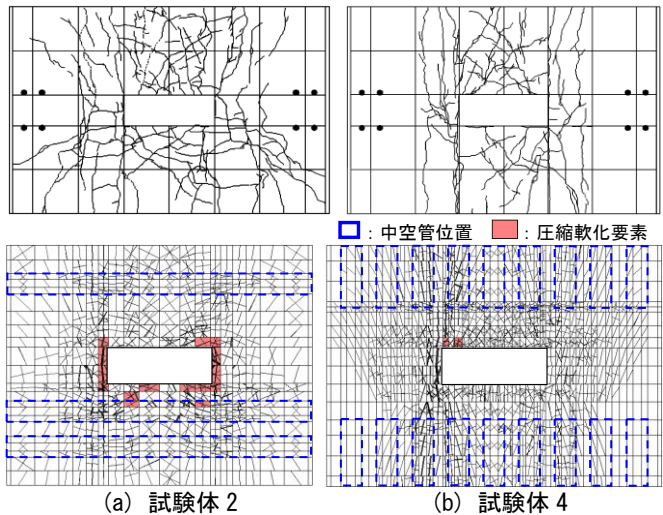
最終ひび割れ状況 (上: 実験, 下: 解析)
